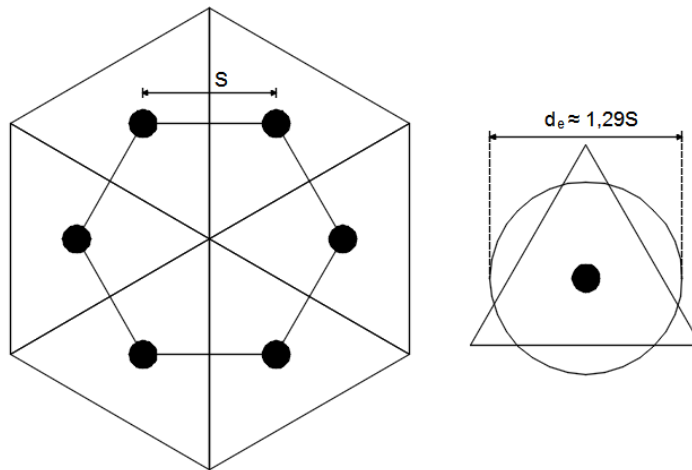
Malha hexagonal de drenos verticais (Assunção, 2010)
